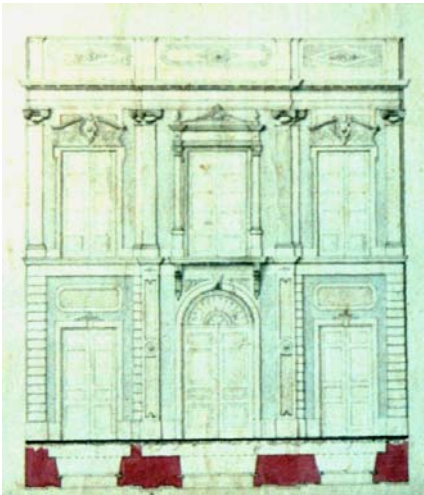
Fachada com aspecto azulado no fundo e pilastras claras. Foto: Natália Naumova
